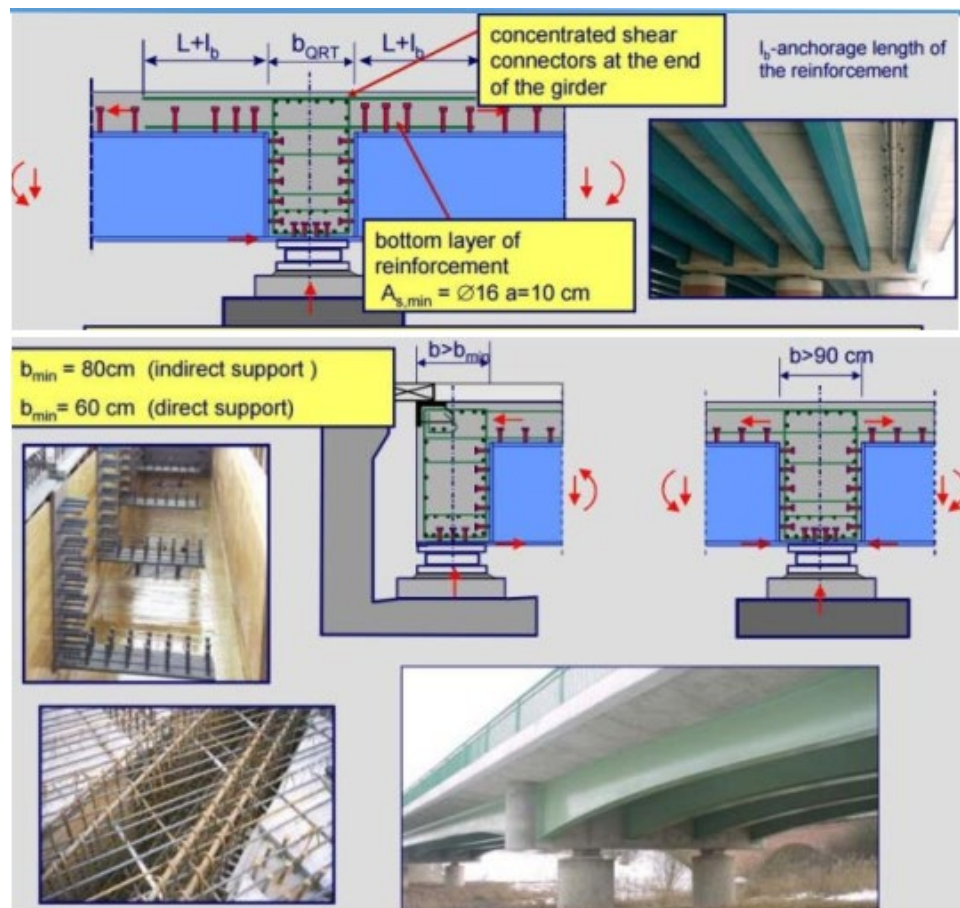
Сталезалізобетонні прогонові споруди які мають з'єднання у вигляді залізобетонних балок над опорами. Конструкція об'єднання.
